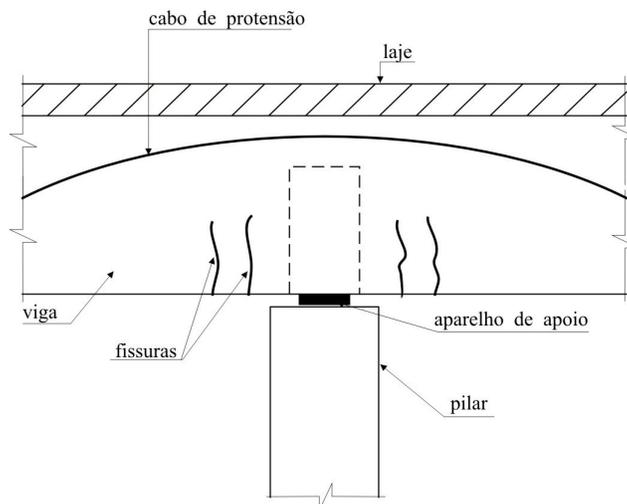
Fissuras verticais em vigas protendidas
